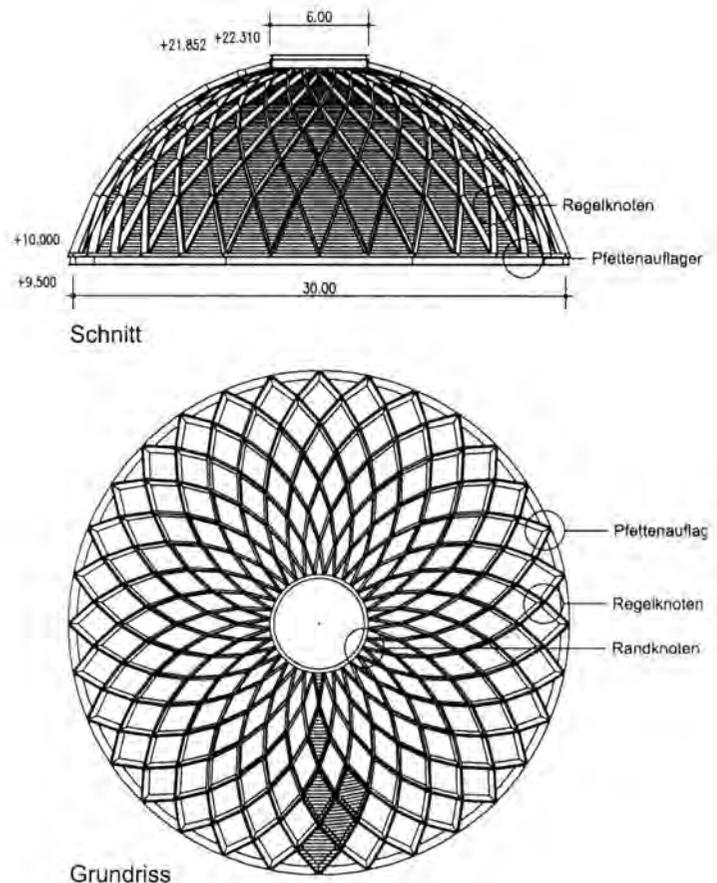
Neue Messe Rimini, Kuppel mit einem Durchmesser von 30 m, Draufsicht und Querschnitt, aus /137/
